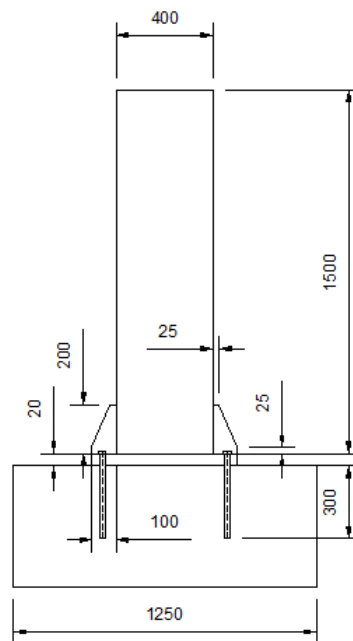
Vista frontal conexión columna tubular rectangular compuesta a cimentación con placa base emperrada y rigidizada. Conexión 4.
